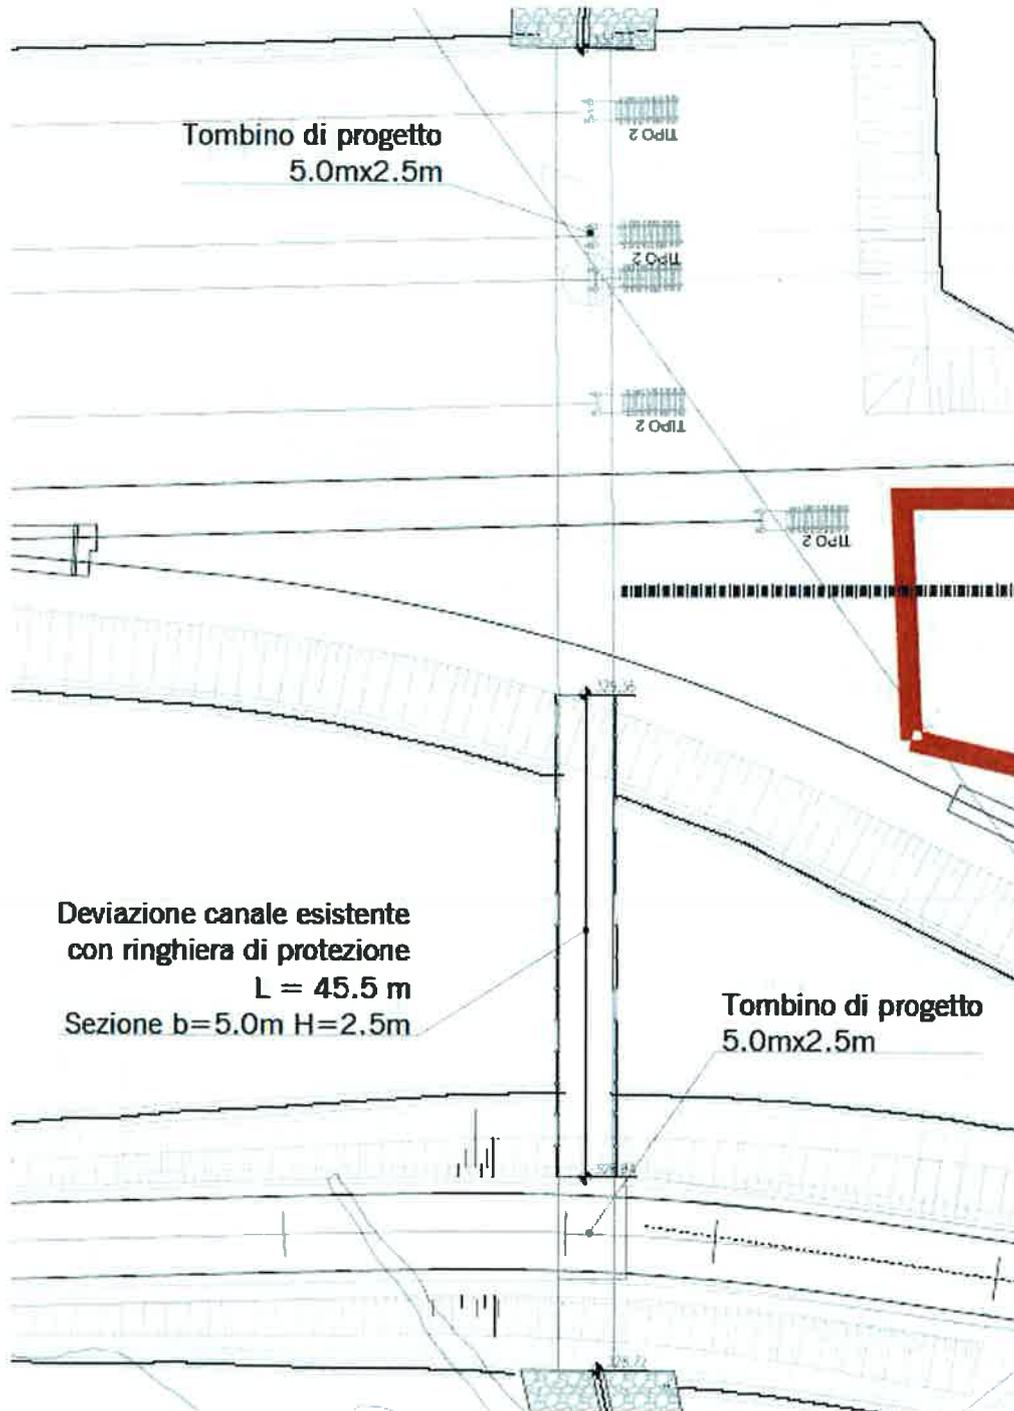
Inalveazione IN01 – tratto in area interclusa. Pianta
